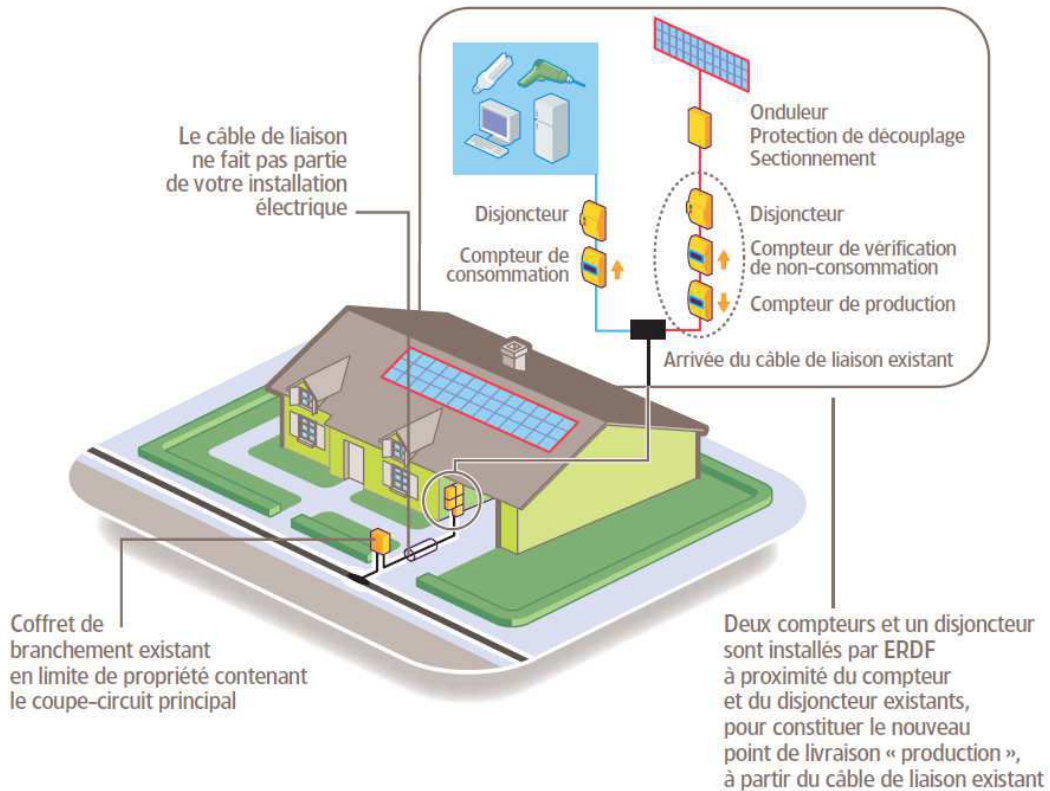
Schéma de branchement d'une installation monophasée [ERD 12]
